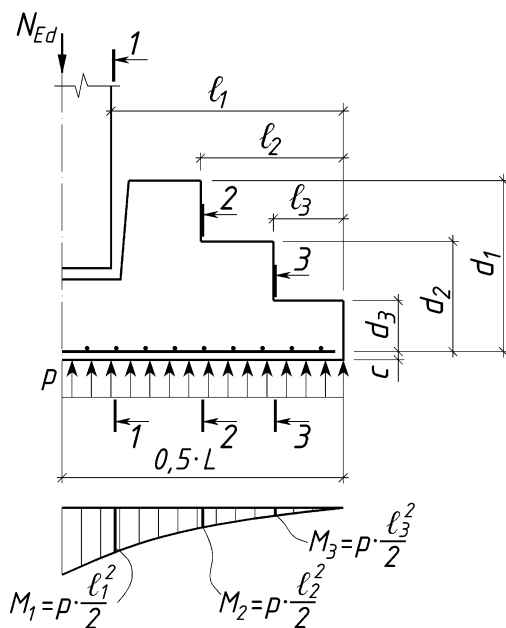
Расчетная схема фундамента при расчете его плитной части
